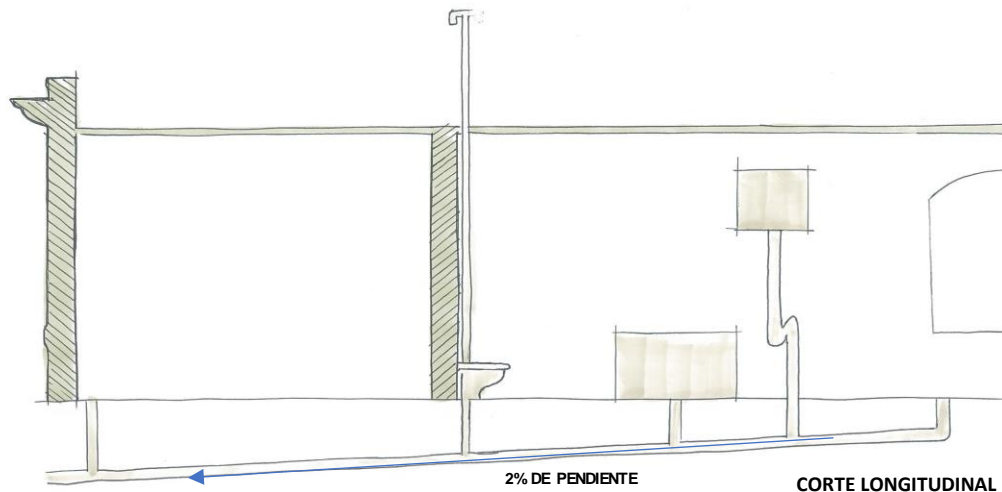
y 41. Detalle en planta y en corte de un albañal.
